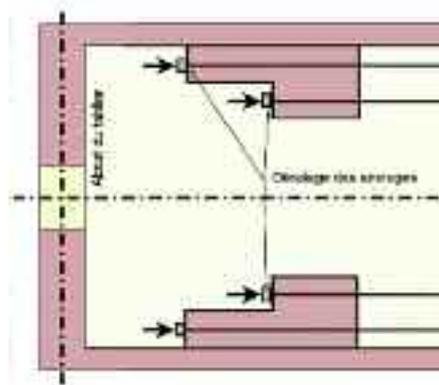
disposition pour limiter les effets d'entraînement en arrière d'un massif d'ancrage
